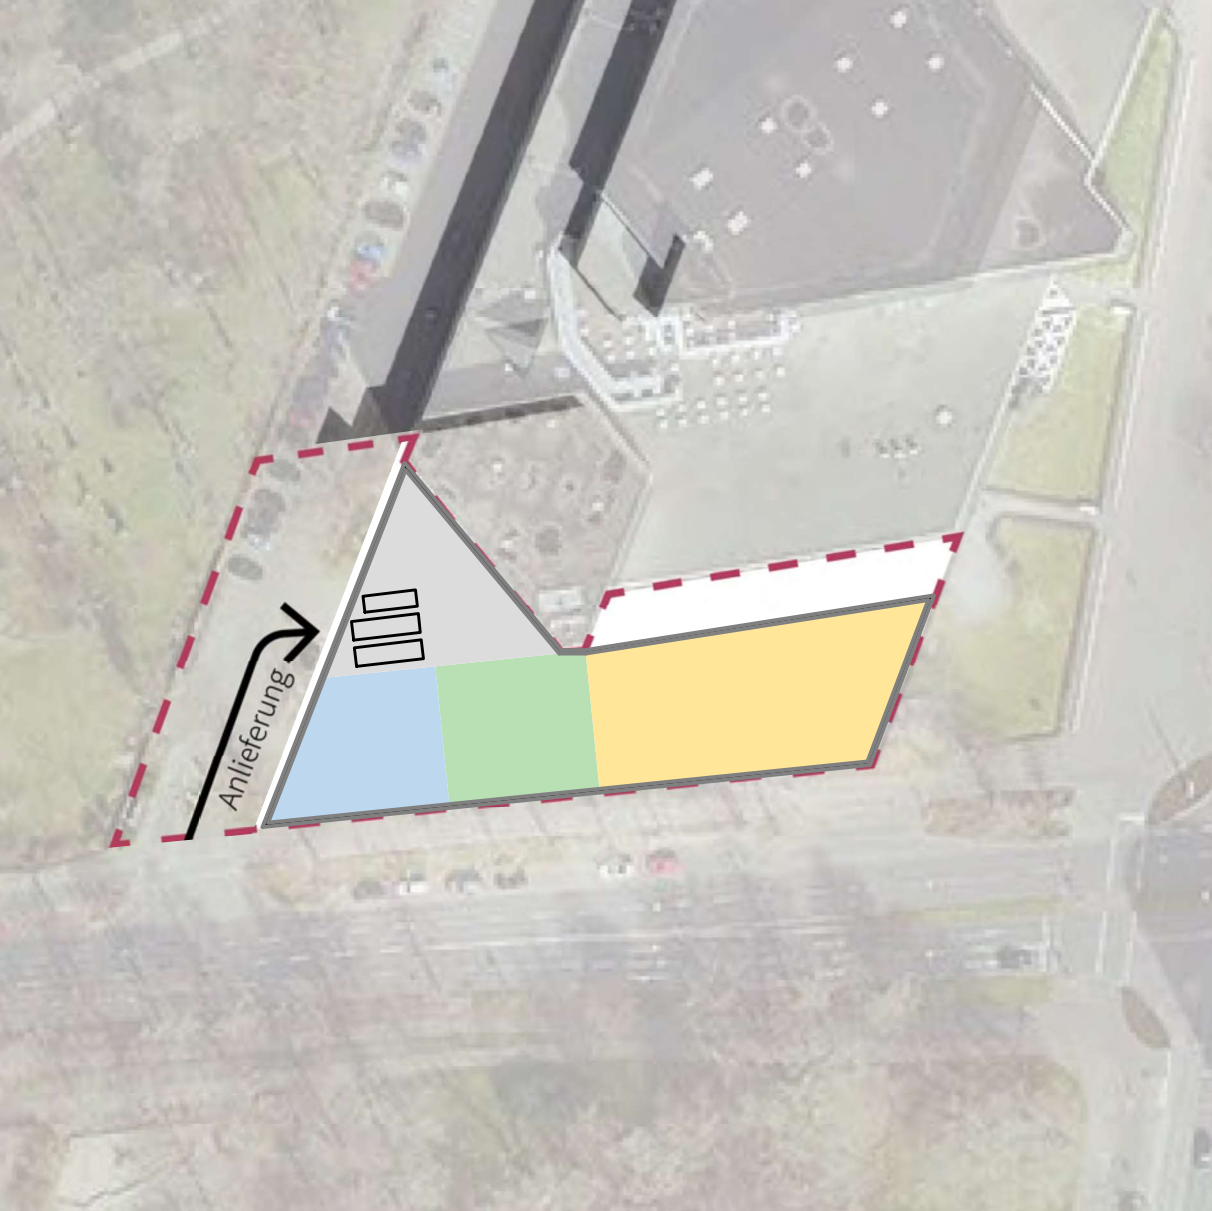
Grundriss EG Stadthalle V2
